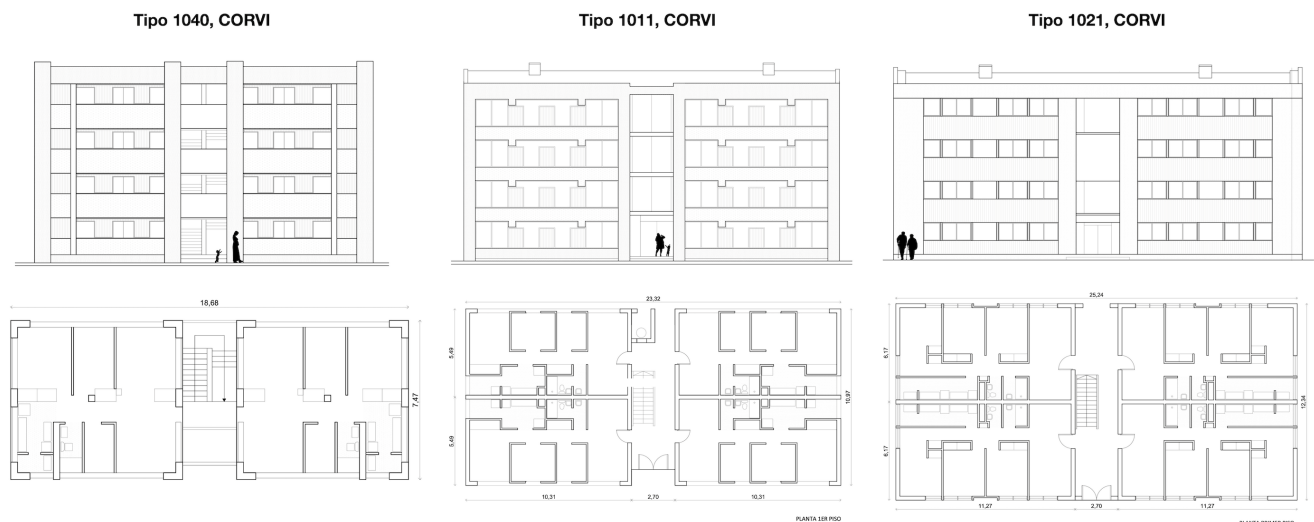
Elevación y plantas de Colectivos de Vivienda tipo 1040, 1011 y 1021, Corporación de la Vivienda. Fuente: Elaboración propia.
